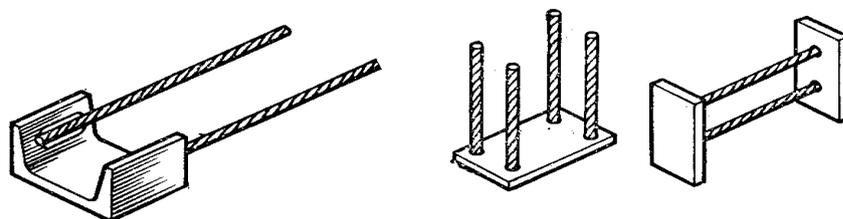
Закладные детали для сборных железобетонных конструкций
